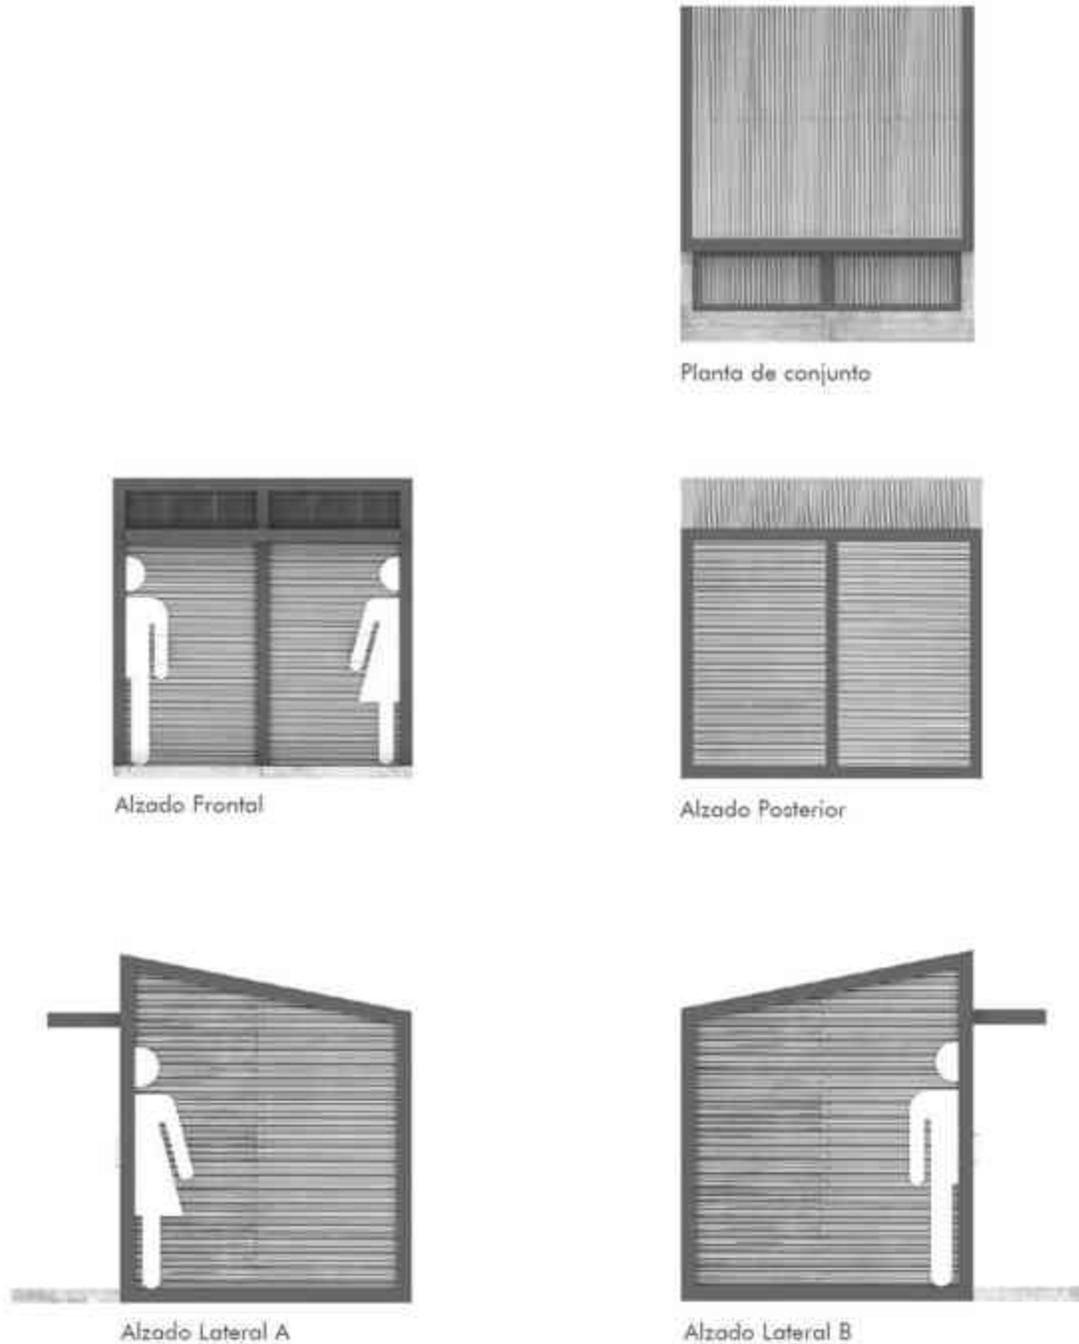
\_* Planta y alzados del Pabellón Polivalente. Imagen Objetivo. Sin escala.
